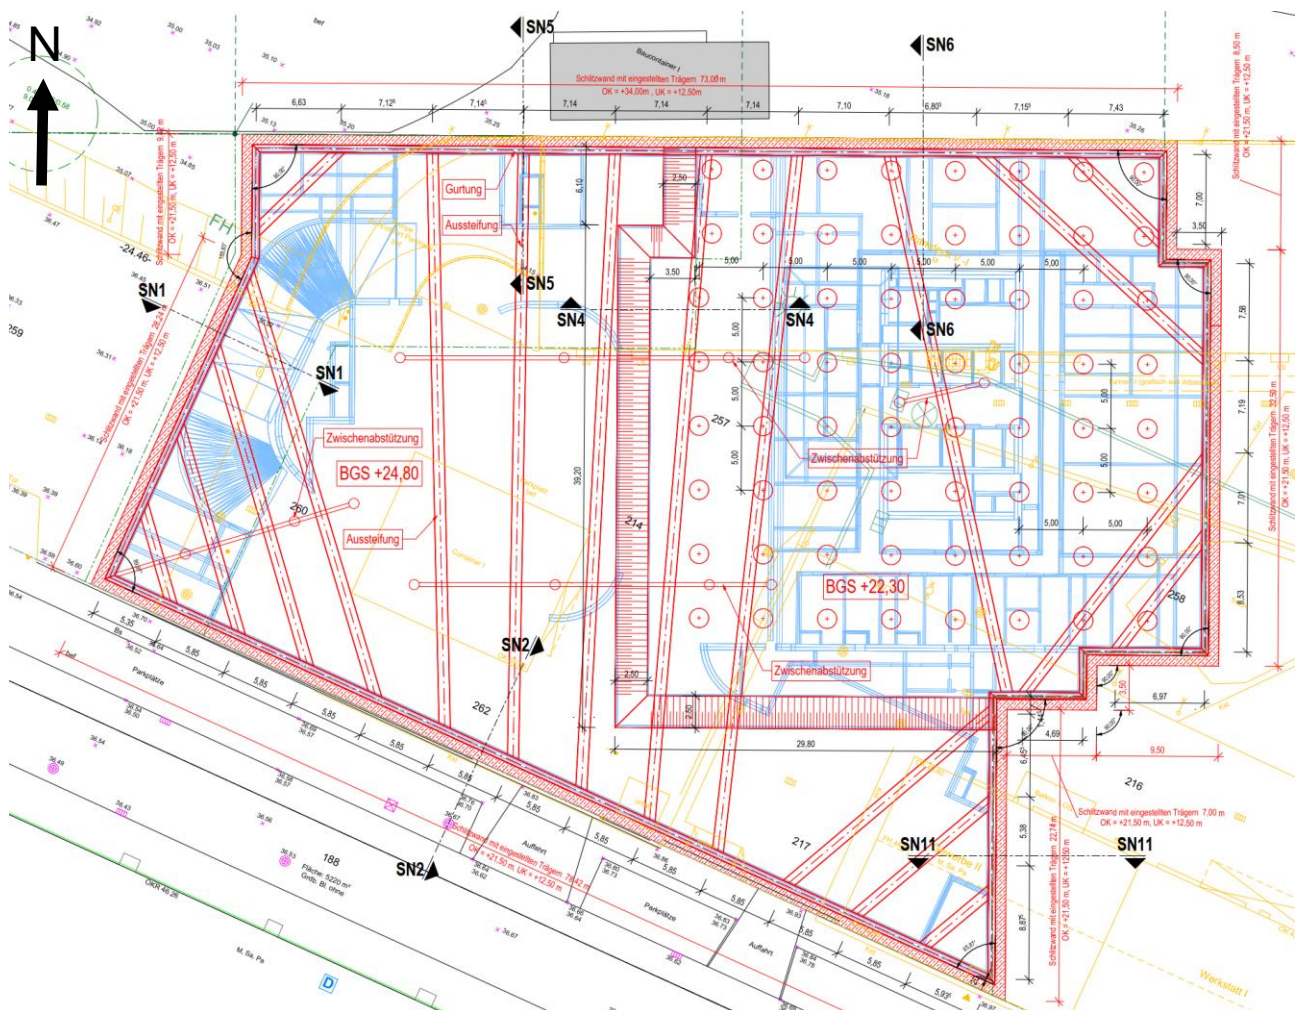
Grundriss Baugrube Bauteil B und C (aus [U 7])
